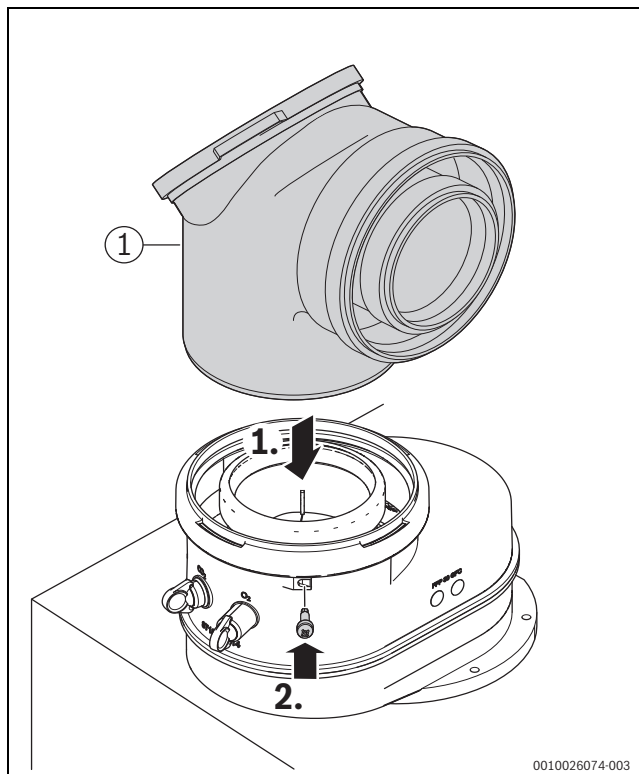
Abgaszubehör einsetzen und mit Schraube sichern
